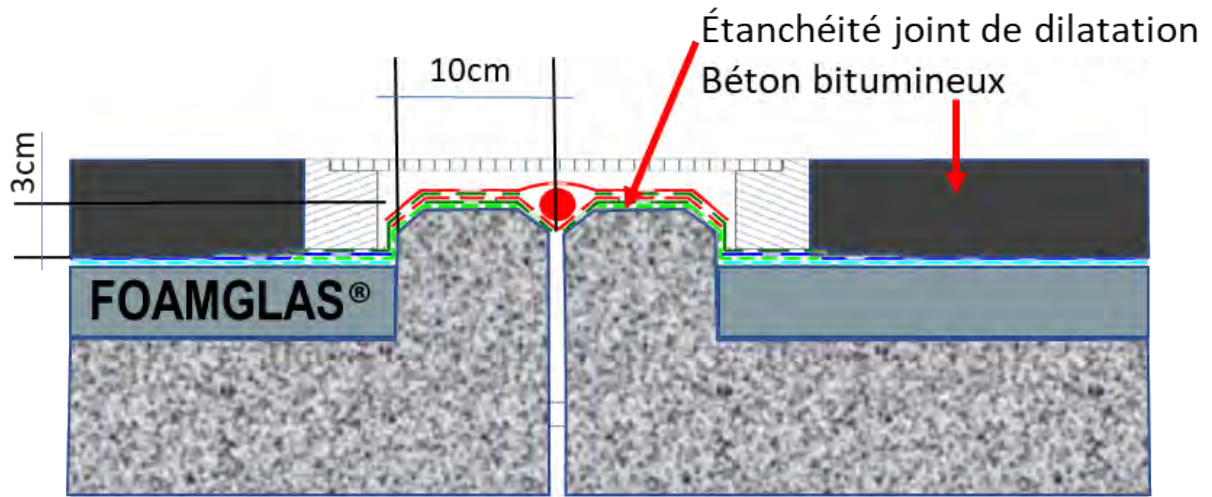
Joint de dilatation en terrasse accessible aux piétons
